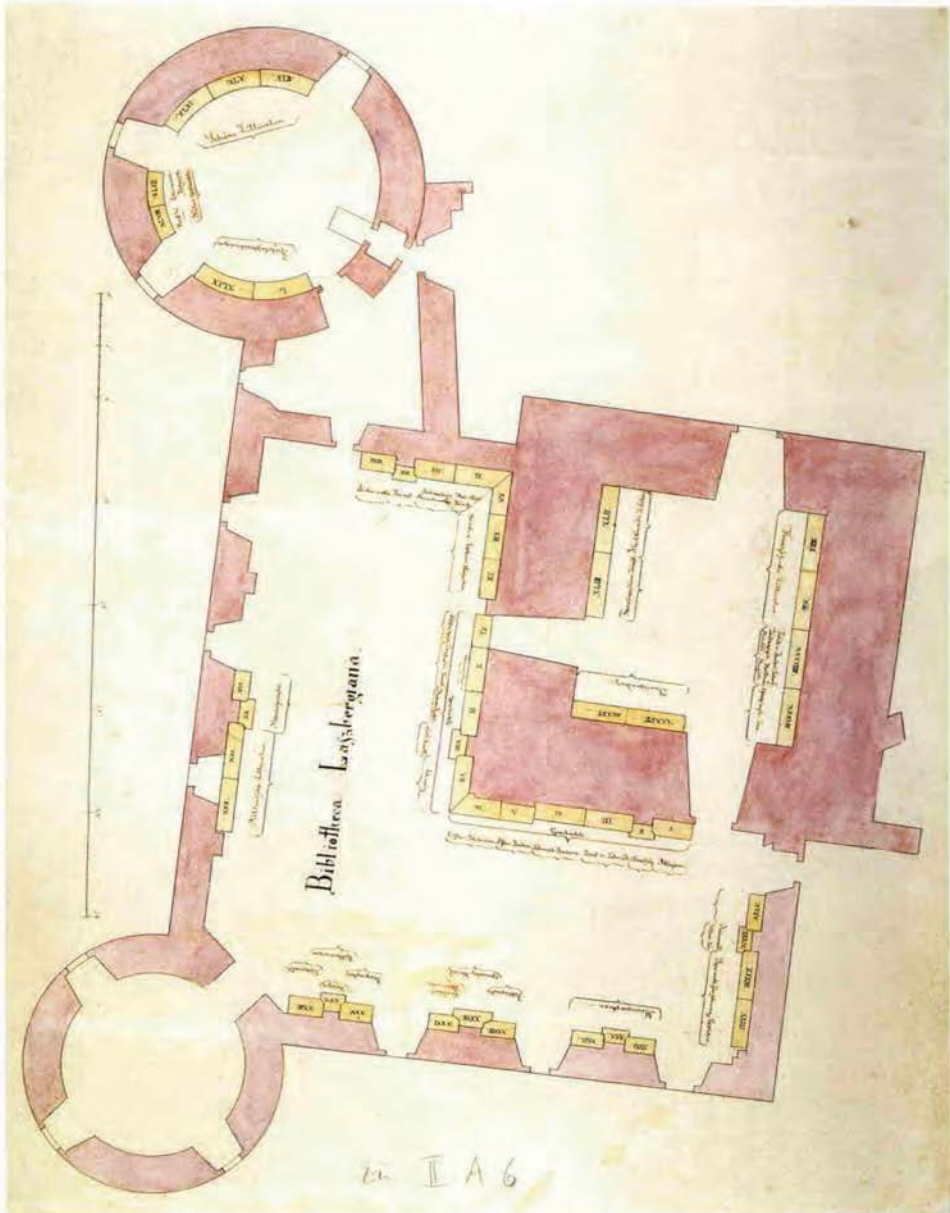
Teilgrundriss der Meersburg mit Bibliotheksplan - Laßberg Nachlass K 2912
